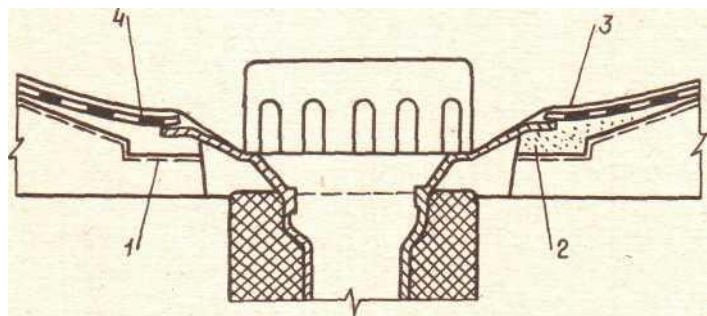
Конструктивное решение ремонтной гидроизоляции зоны водоприемной воронки: 1 - зона очистки старой изоляции до бетона; 2 - полимерно-битумный раствор с наполнителем; 3 - двухслойная армированная стеклотканью гидроизоляция на полимерно-битумной мастике; 4 - защитное покрытие из полимерно-битумной мастики
